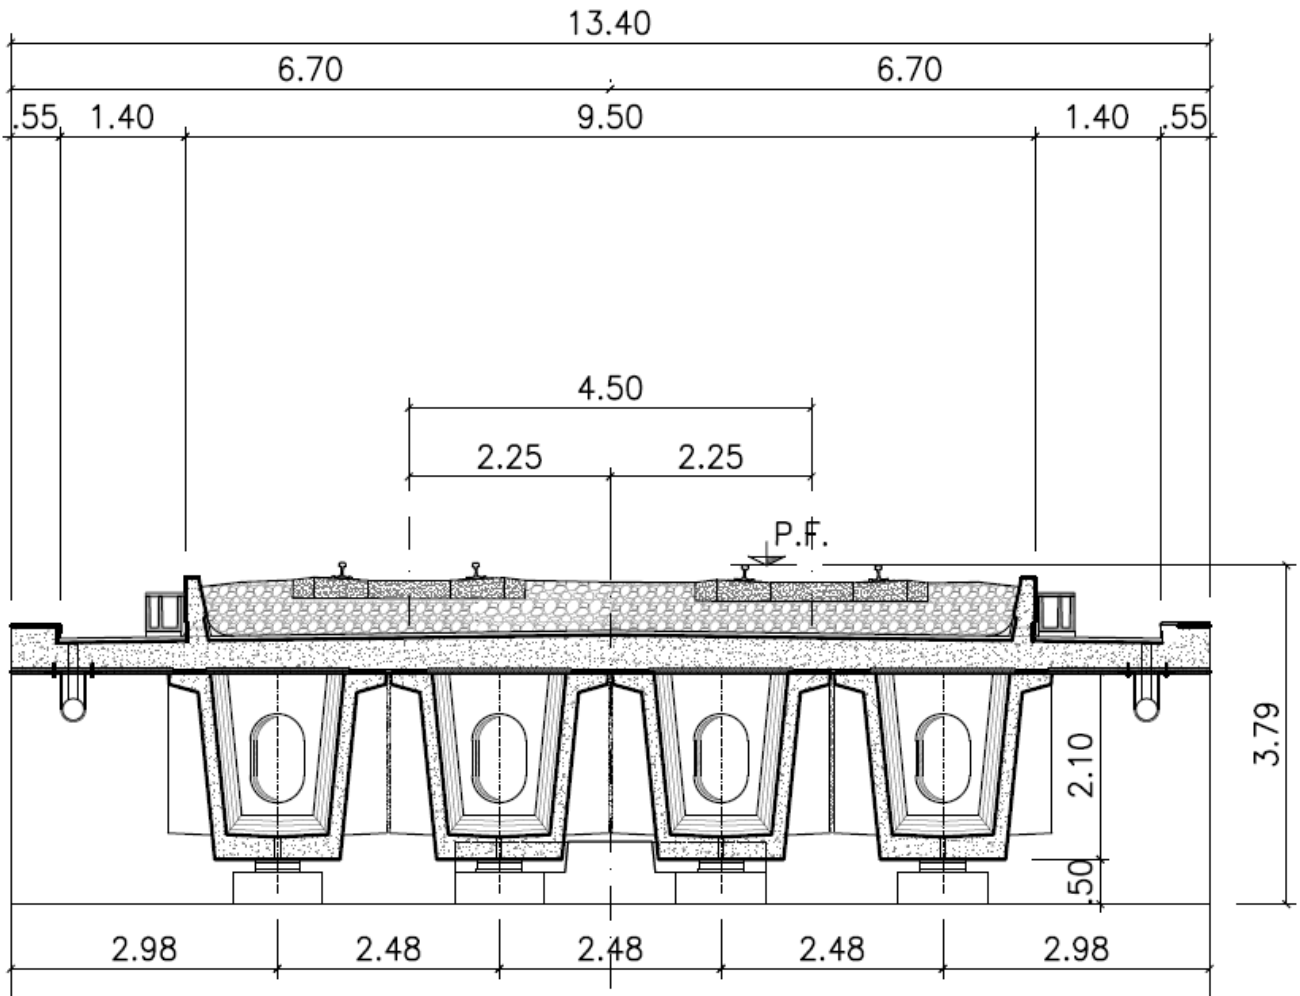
Sezione trasversale tipo dell'impalcato con travi in c.a.p.
